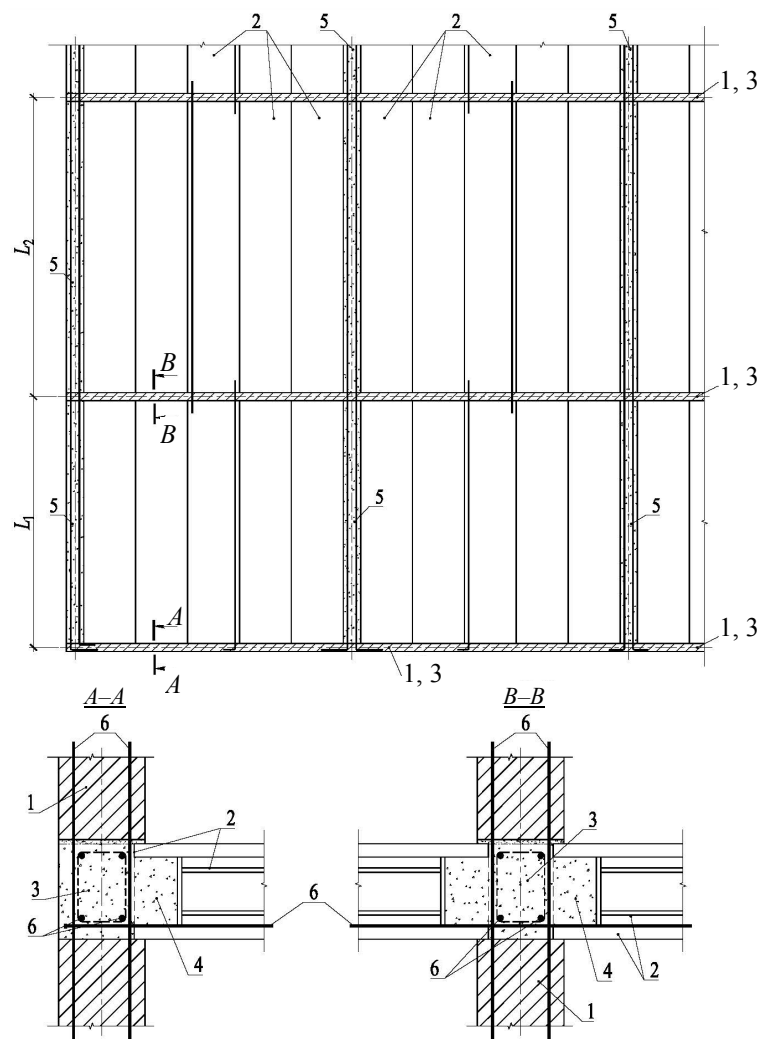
Плоское сборно-монолитное перекрытие, образованное многопустотными плитами безопалубочного формирования и опертое на несущие стены: 1 – несущая стена; 2 – сборная многопустотная плита; 3 – монолитный несущий ригель; 4 – бетонная шпонка несущего ригеля; 5 – связевый ригель; 6 – арматура внутренних сквозных связей
